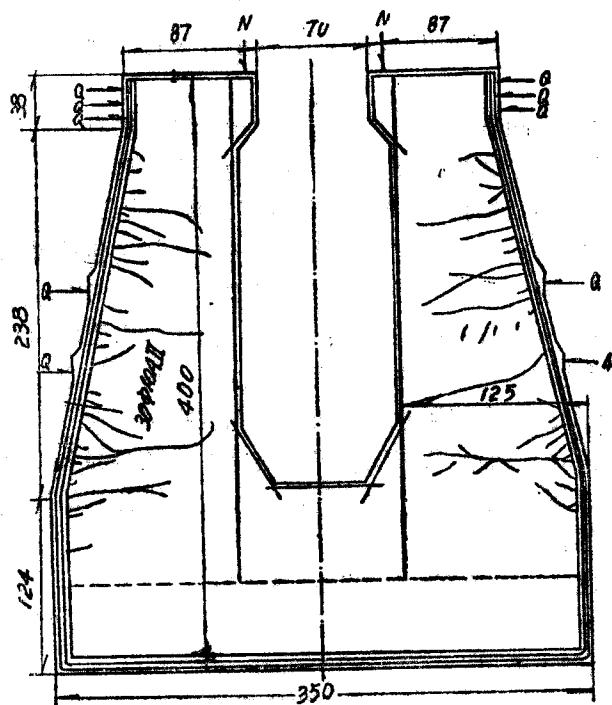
坞式钢筋混凝土结构模型（经重复加载1000次后的裂缝形状）
